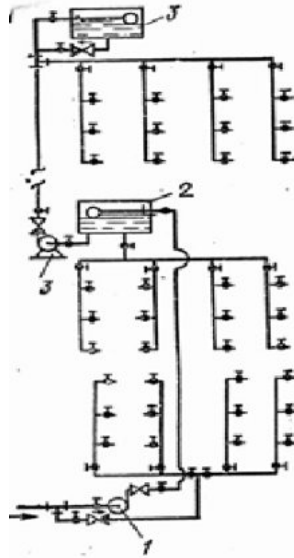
Последовательная схема зонных водопроводов зданий:
